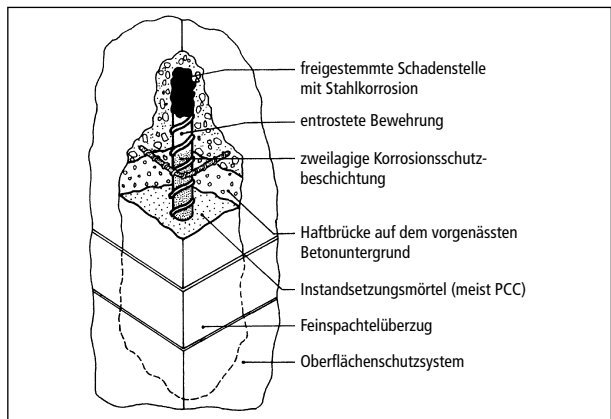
■ Systemdarstellung der Betoninstandsetzung mit kunststoffmodifiziertem Zementmörtel, nach [39]
